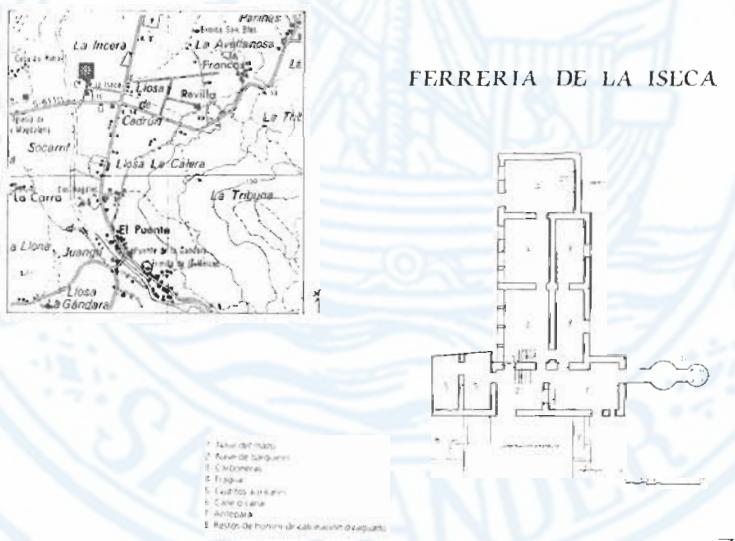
Plano de una ferrería. Ferrería de La Iseca, valle de Guriezo.
